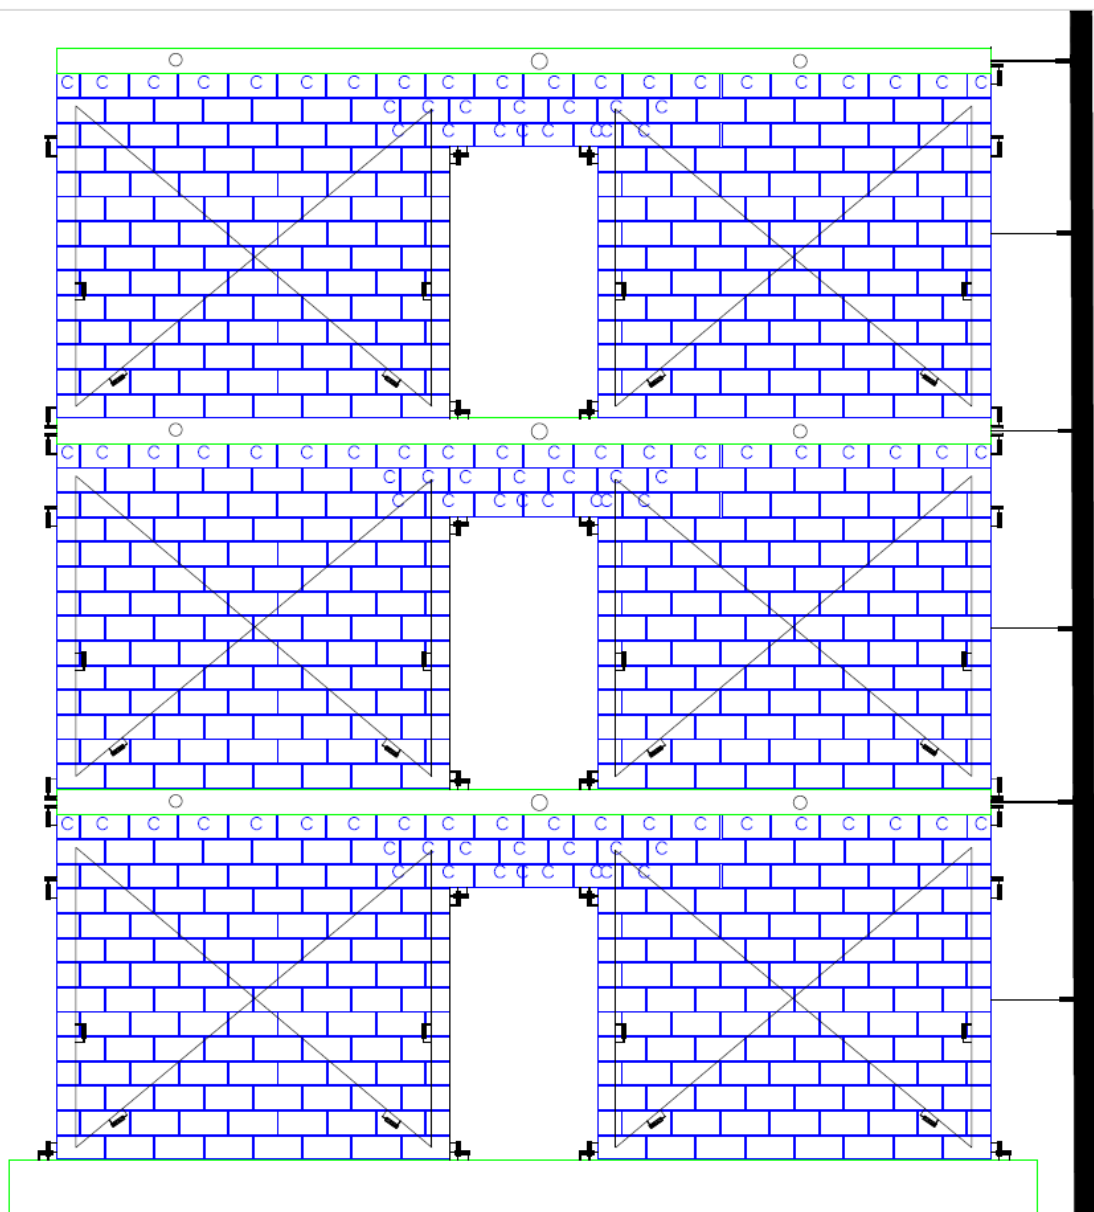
Ilustração da Instrumentação colocada nas paredes para o ensaio.,
